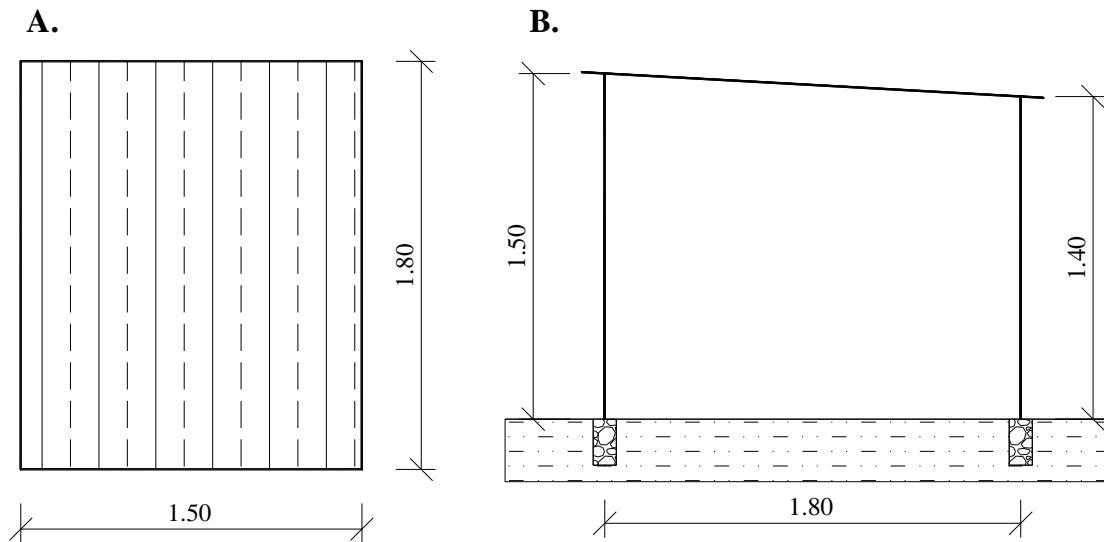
Planta baixa (A) e corte longitudinal do abrigo individual (B)
